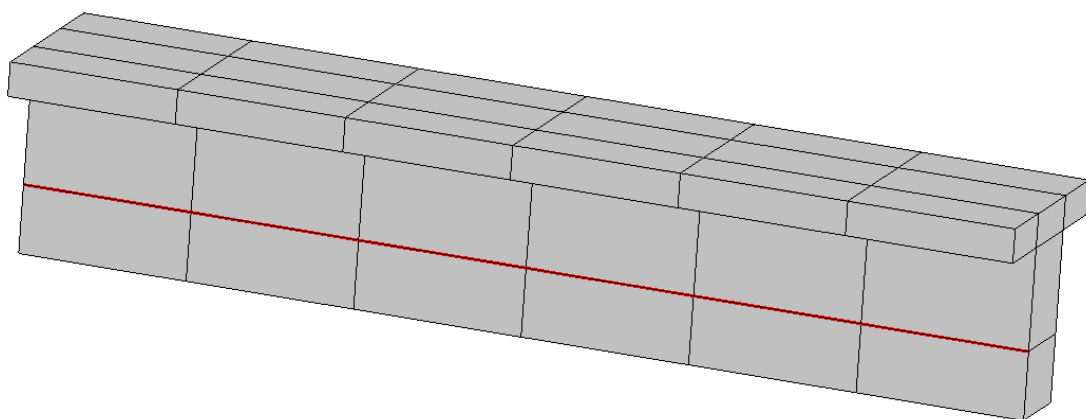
Malha de elementos de concreto e armadura ativa para a viga.
